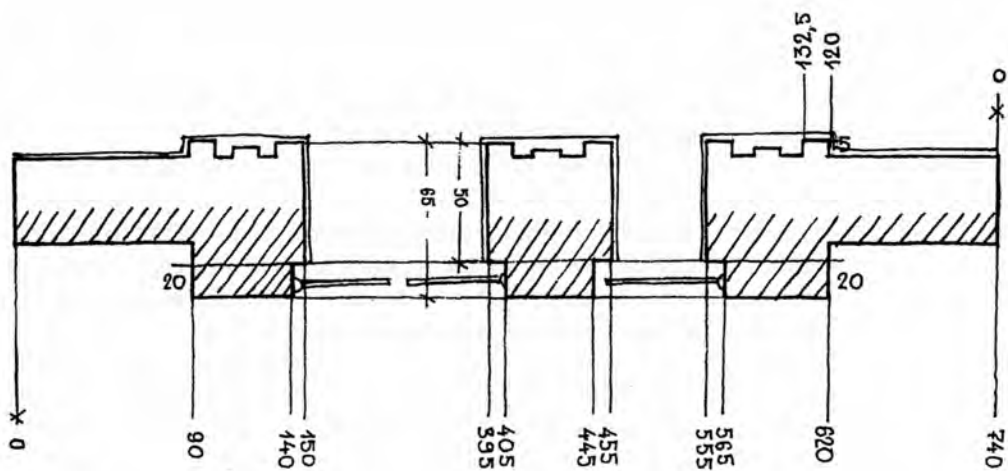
Обмеры плана: обмеры фрагмента памятника; план ворот
